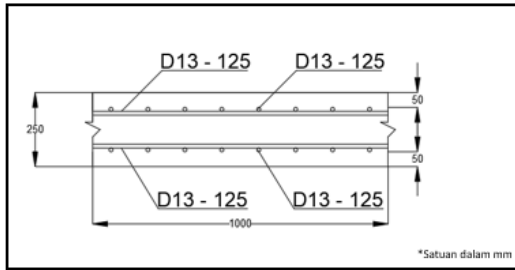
Detail tulangan balok non crane-1 arah melintang
